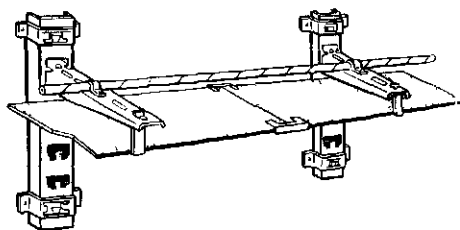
18. Примеры прокладки на сборных кабельных конструкциях
